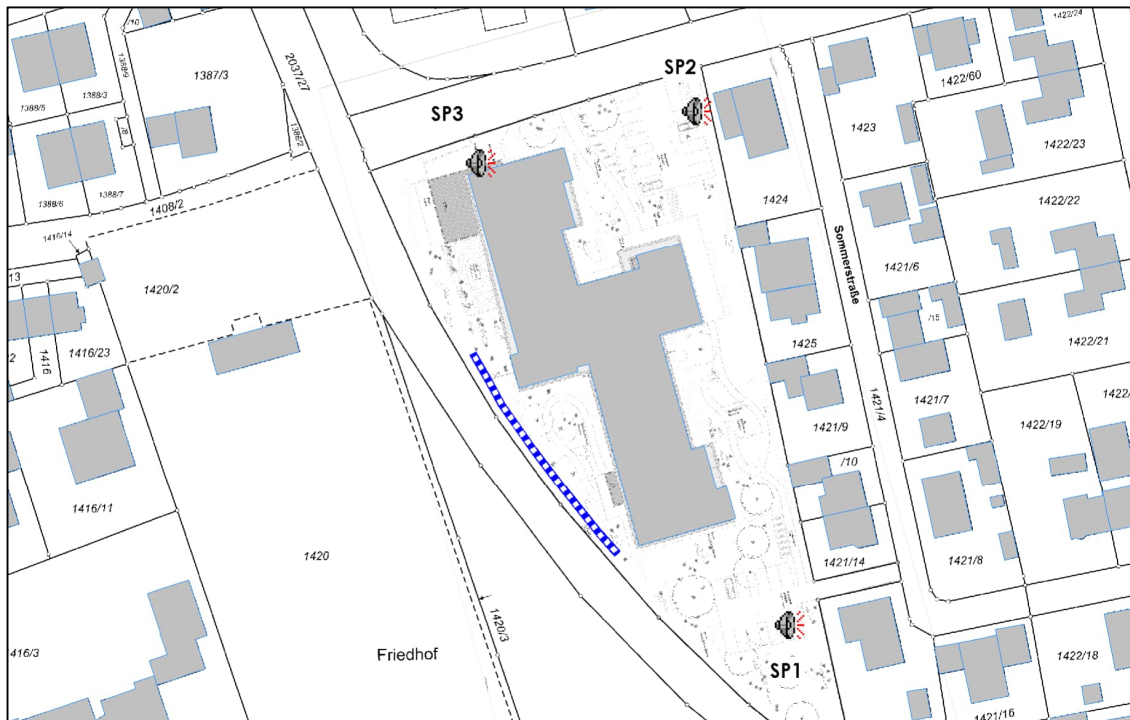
Lageplan mit Darstellung der betrachteten Spitzenpegel
